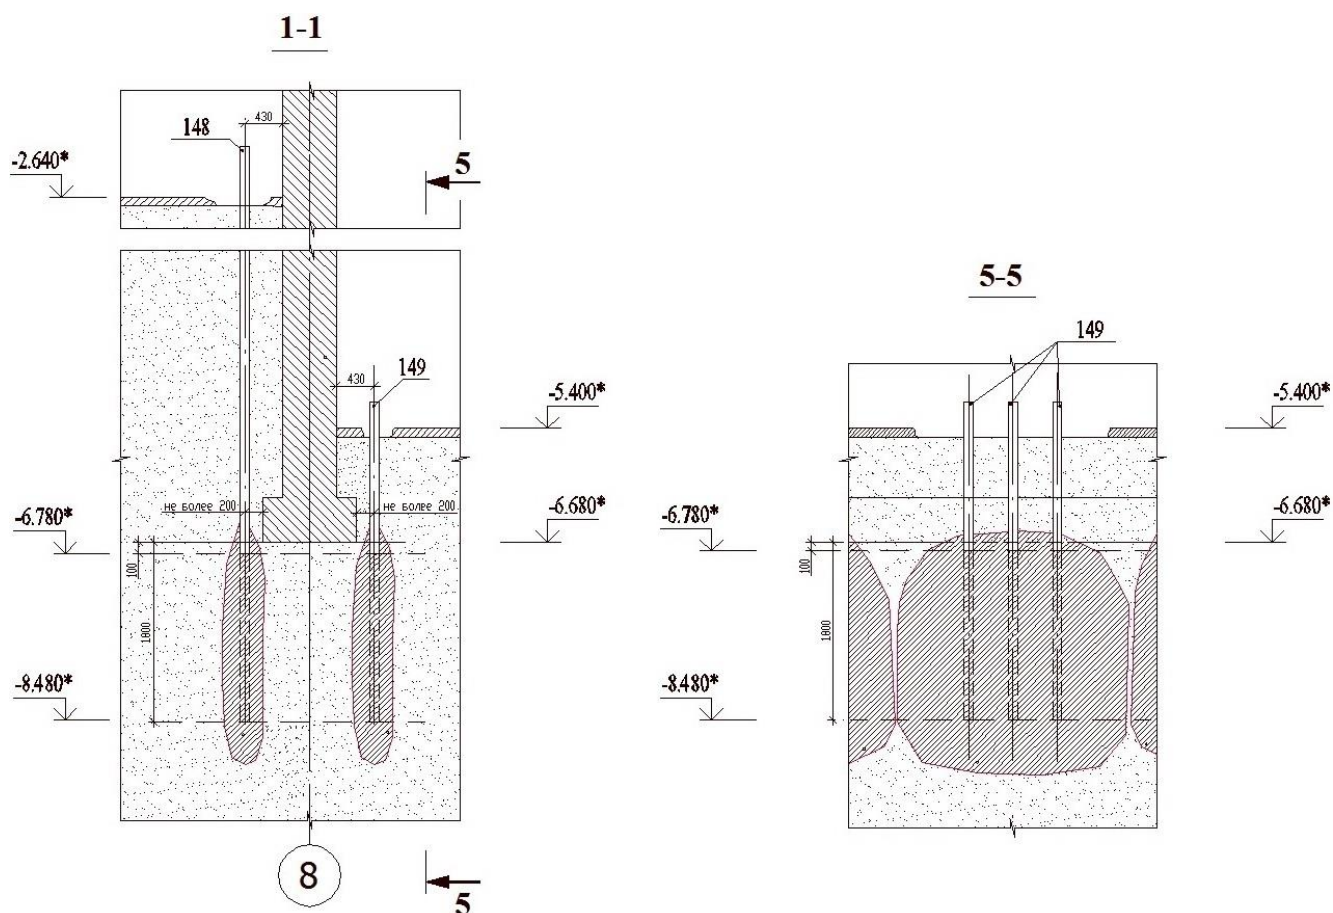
Жилой дом № 40 по ул. Октябрьской в Новосибирске: схема усиления ленточных фундаментов контурным армированием.
